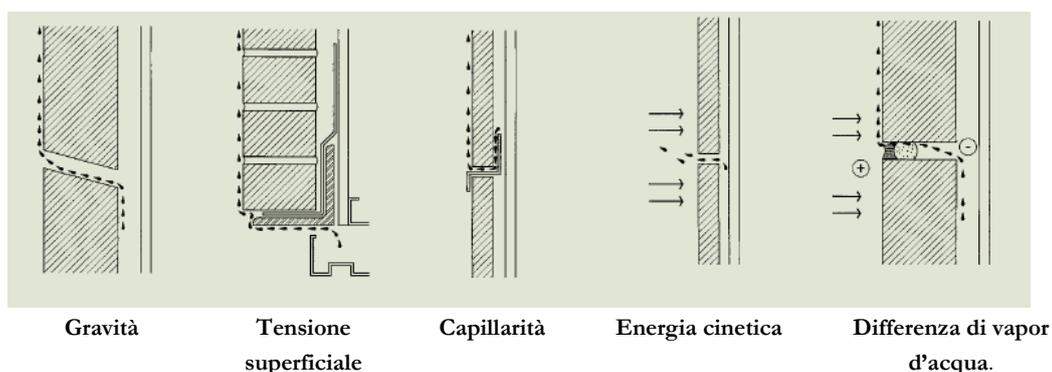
I quattro principali vettori causa di penetrazione d'acqua.
